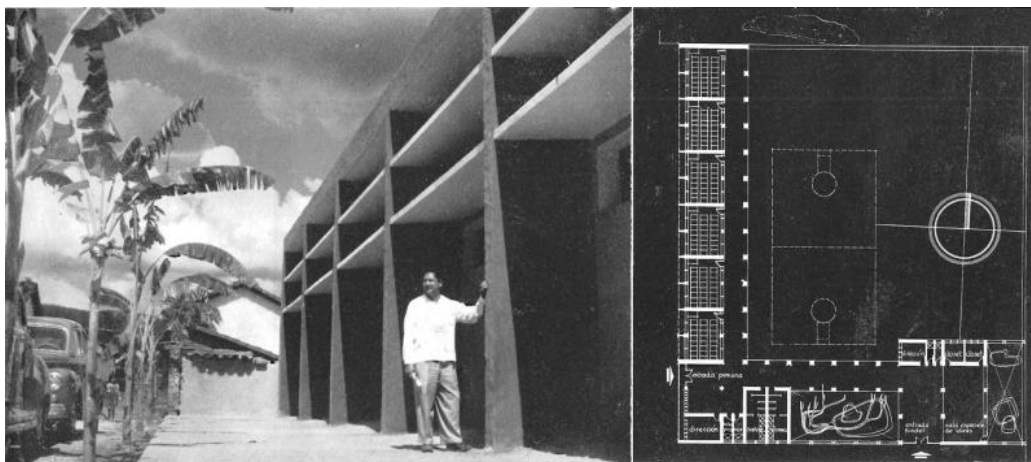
Fachada y planta general del Centro escolar en Cintalapa, Chiapas (1947-1948). *Espacios*, núm. 7 (1951).
